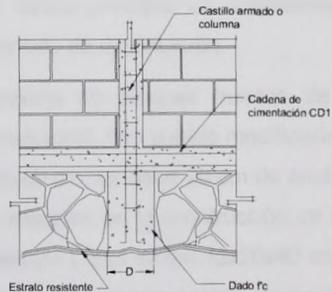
Detalle de cadena de cimentación y anclajes de castillos armados
